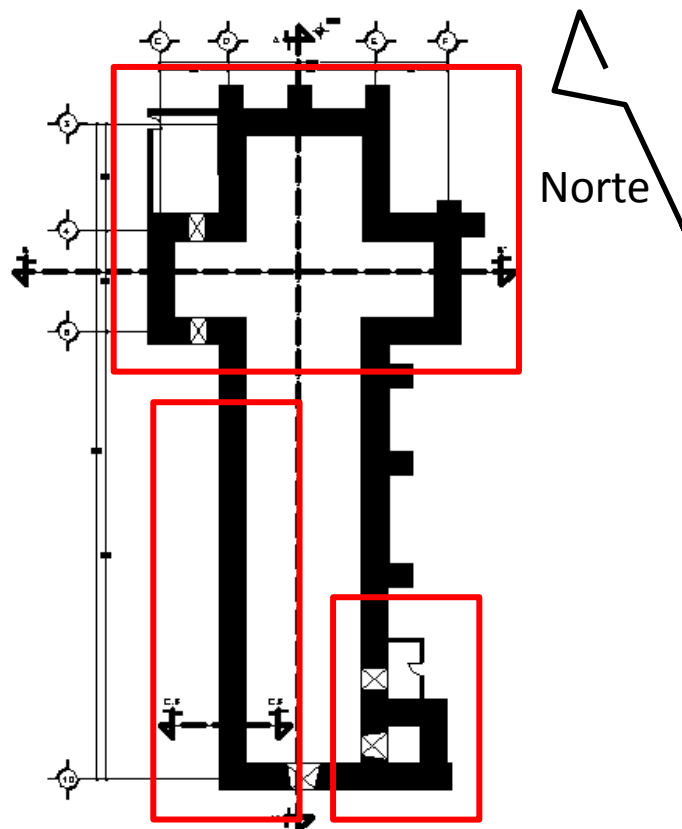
Planta de San Jerónimo de los siglos XIX y XX
